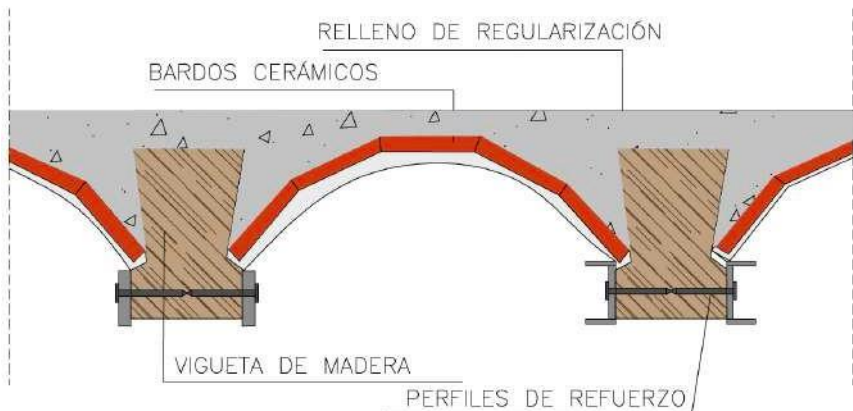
Refuerzo con perfiles metálicos anexados debajo cada vigueta.
